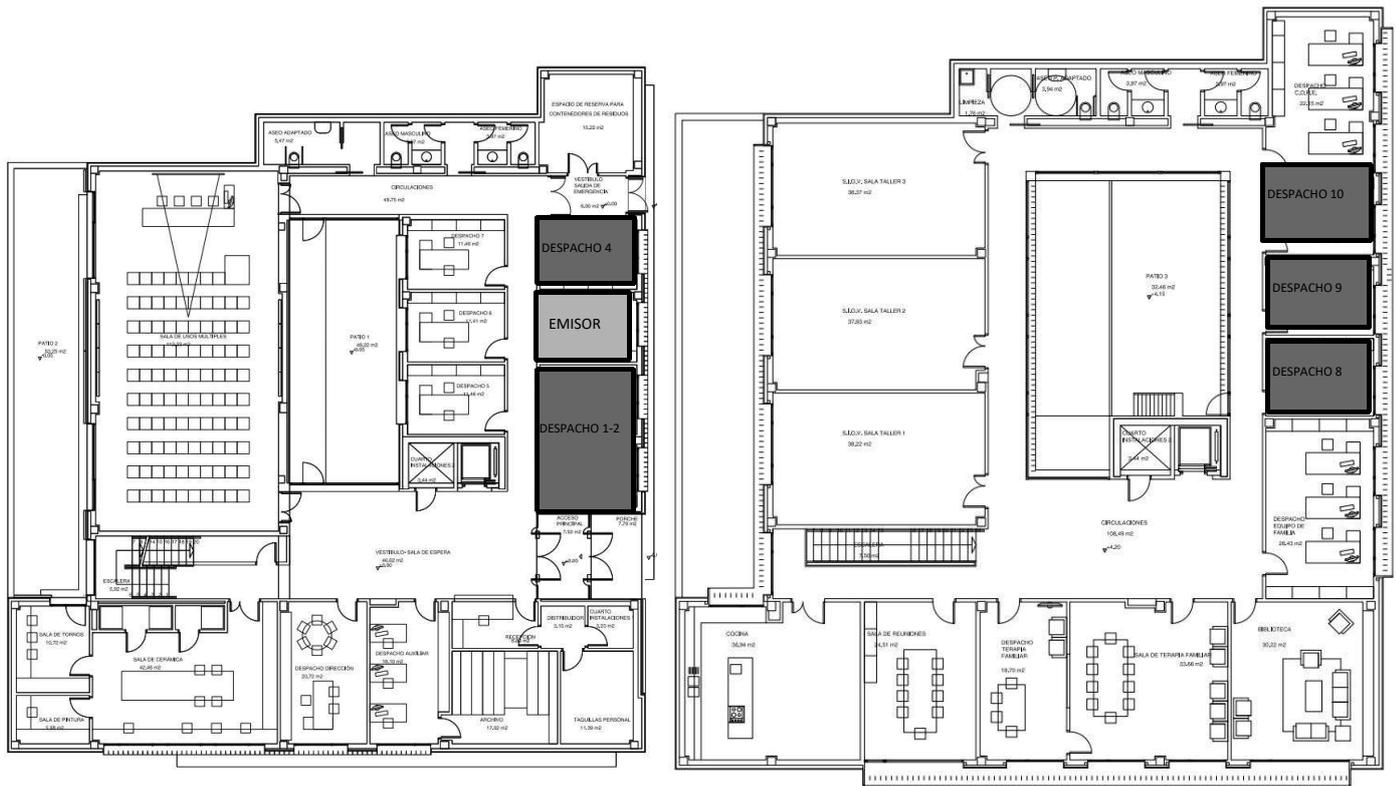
Plano planta baja (I) y planta primera (D) del “Edificio Socio cultural”
